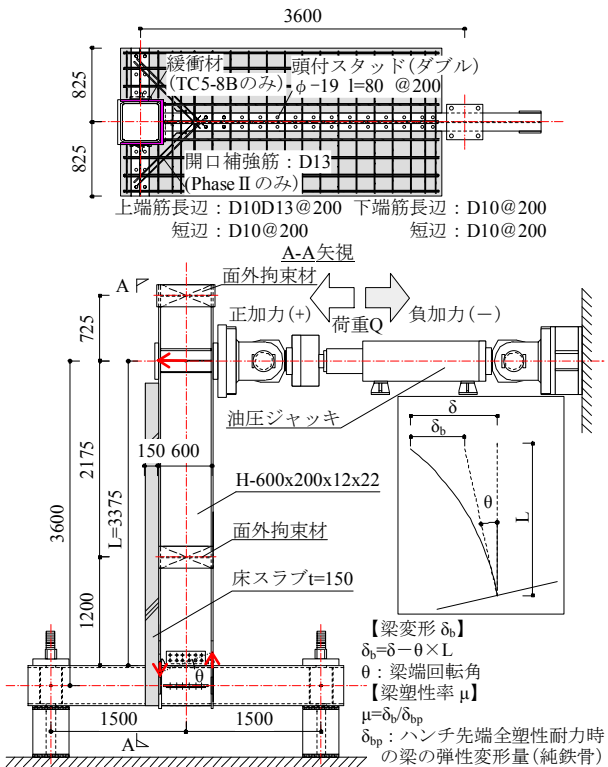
試験体形状および載荷装置 Specimens and Loading System
